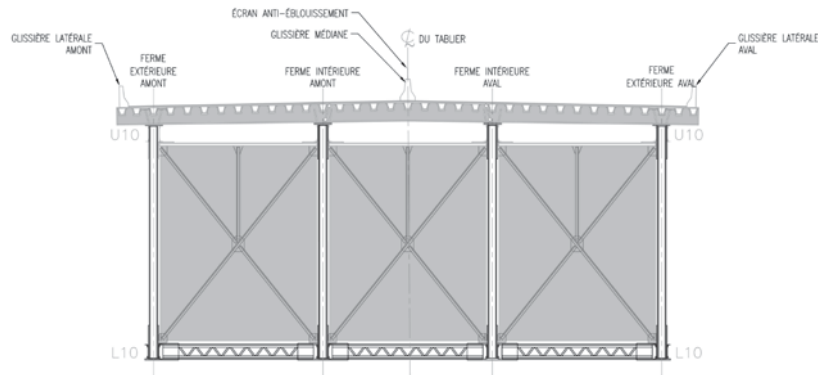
Coupe type travées 4W-2W/2E-4E – Section 6 (source : dessins nomenclature PJCCI)
